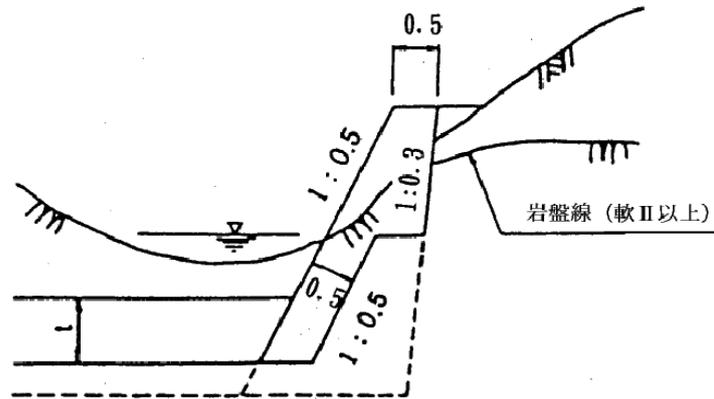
側壁護岸の構造（岩盤（軟Ⅱ以上）の場合）
